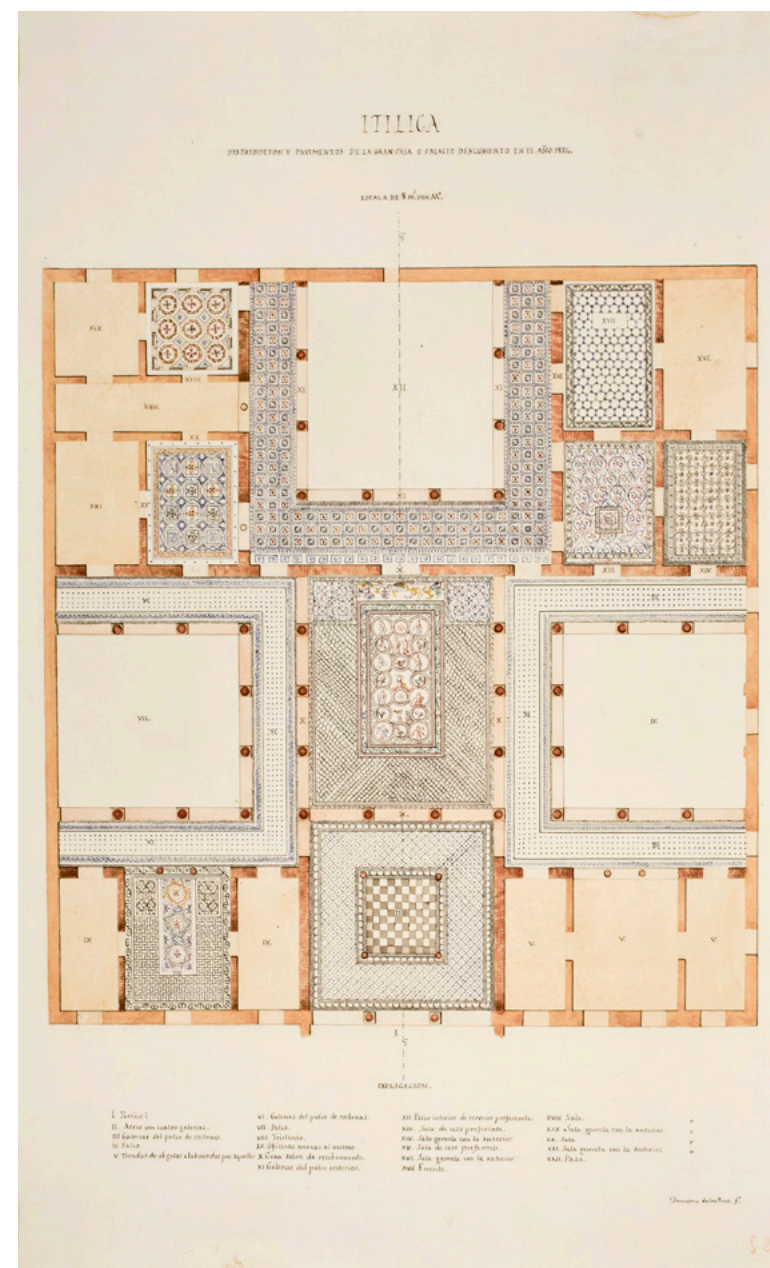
Planta de la llamada Casa Segunda dibujada por Demetrio de los Ríos
